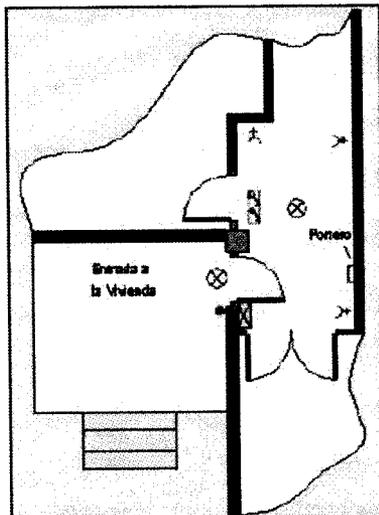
Figura D: Plano de planta del acceso de la vivienda y el vestíbulo
